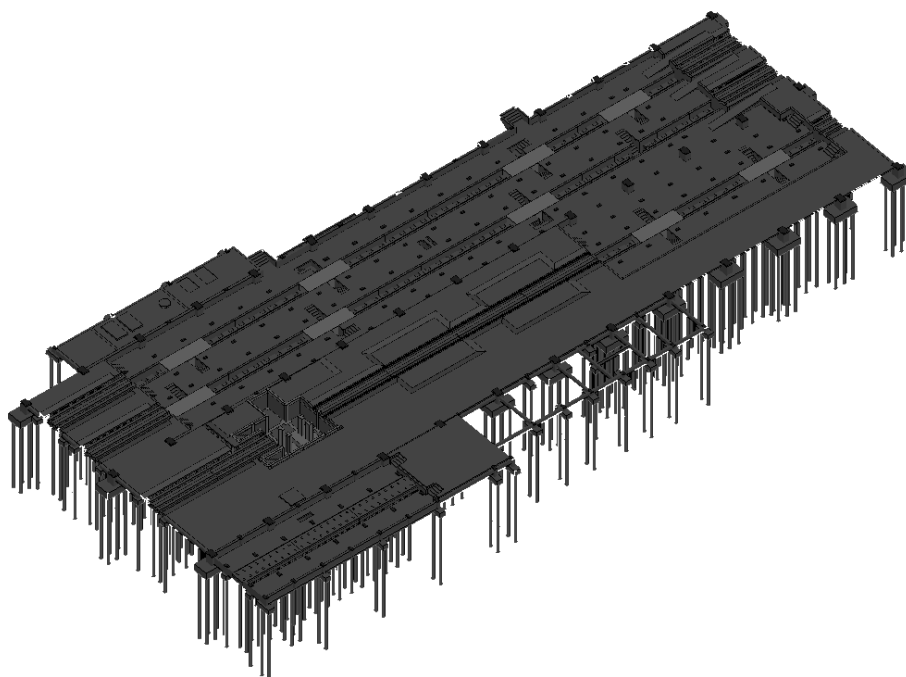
Visão 3D das estruturas de concreto do galpão.
